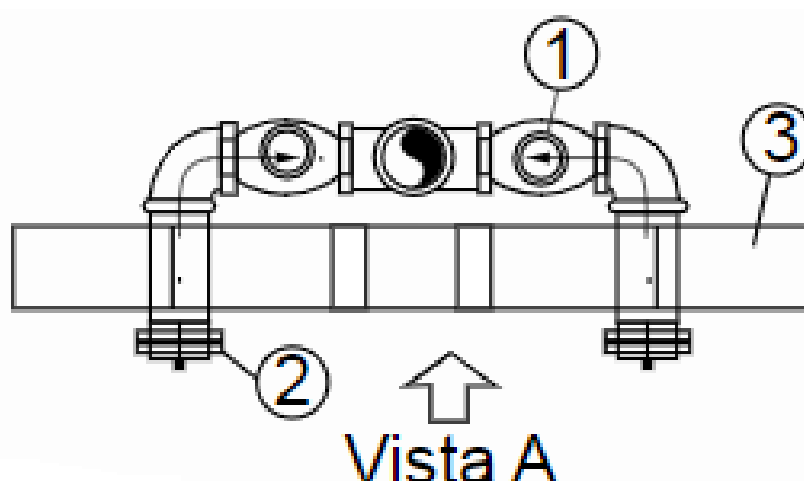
Vista do Recalque> Legenda: 1. Válvula de retenção. 2. Adaptador storz com tampão. 3. Parede de alvenaria. Fonte: O autor.
